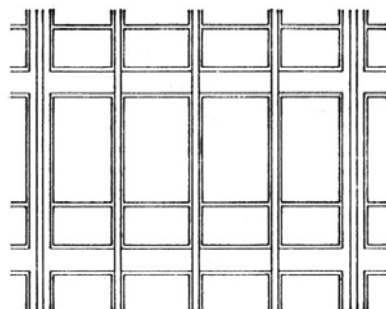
Lake Shore Drive Apartment Buildings, Chicago, 1948–1951, Fassade
